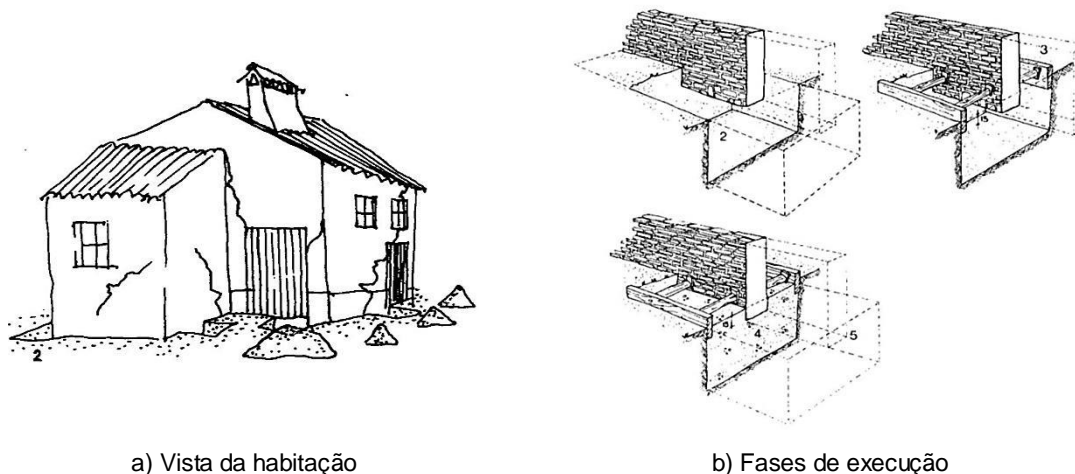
Adossamento exterior à fundação de sapata em betão armado, travada com vigas de betão armado dispostas perpendicularmente
